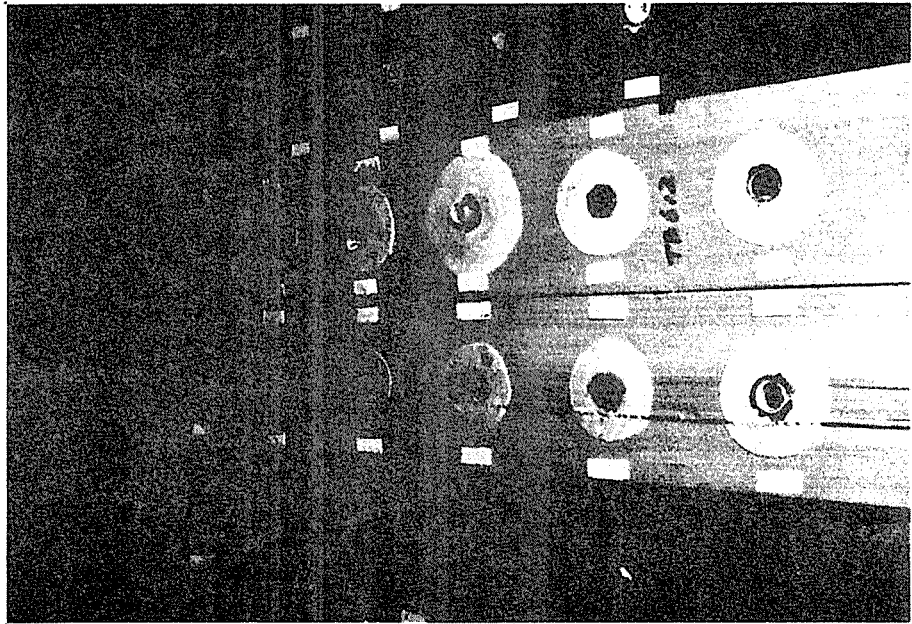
1列の場合 エポキシ充填6本打ちボルト接合供試体の破壊状況
